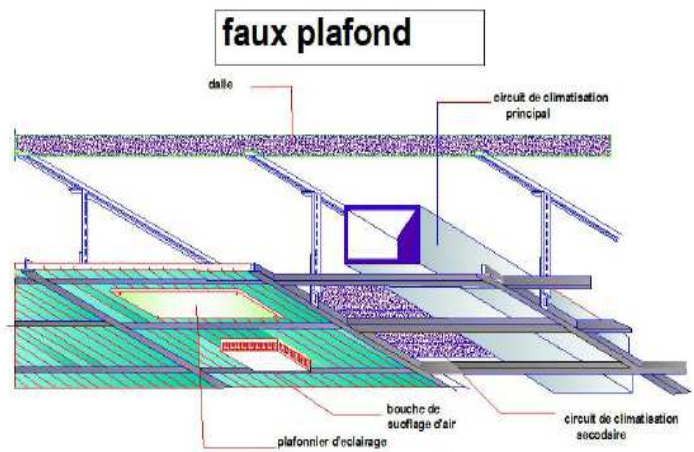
Détail d'un faux plafond; source : <http://www.louis-vigneron.fr>
